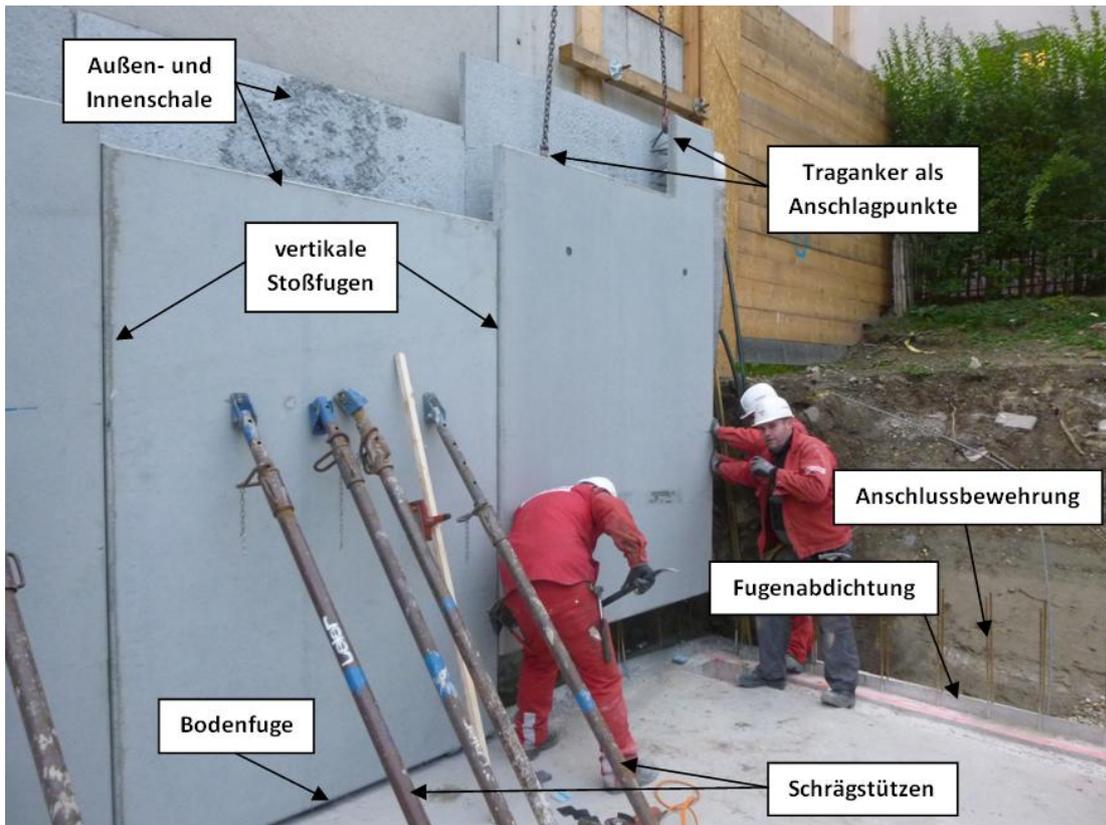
Versetzen einer Elementwand - Begriffe [HÜB16]
